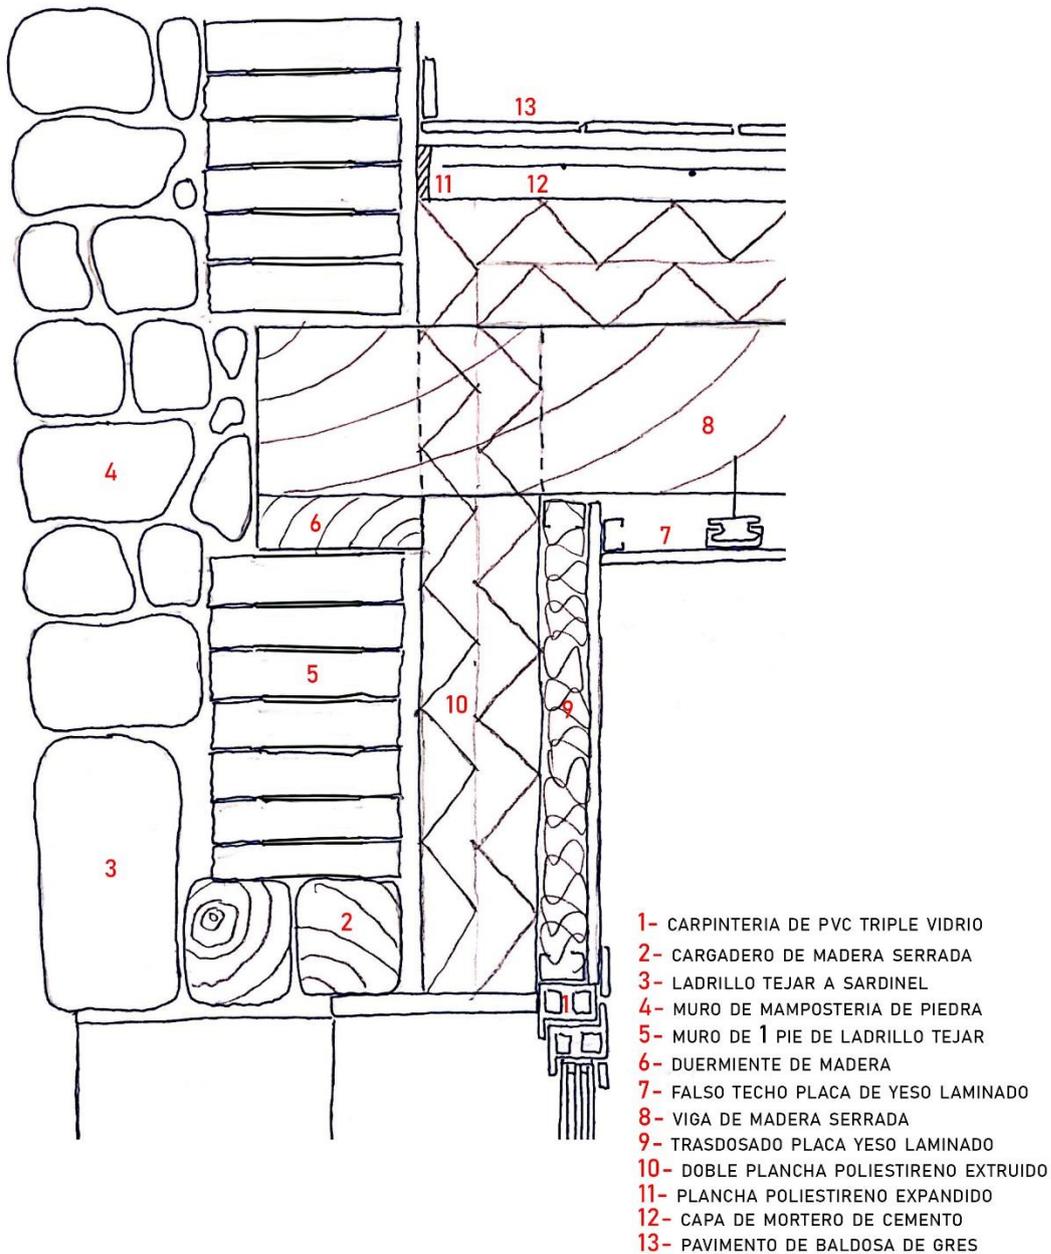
Detalle constructivo reformado – Huevo superior – forjado intermedio (2 alturas)
